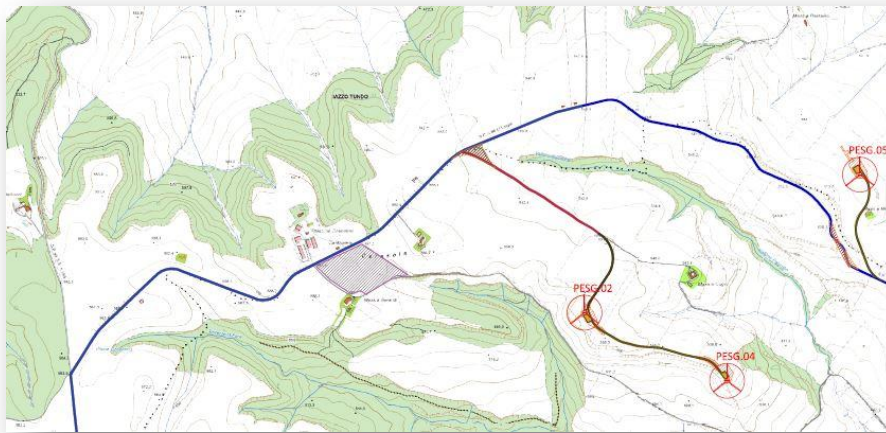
Individuazione Area di cantiere per lo stoccaggio (in grigio)
